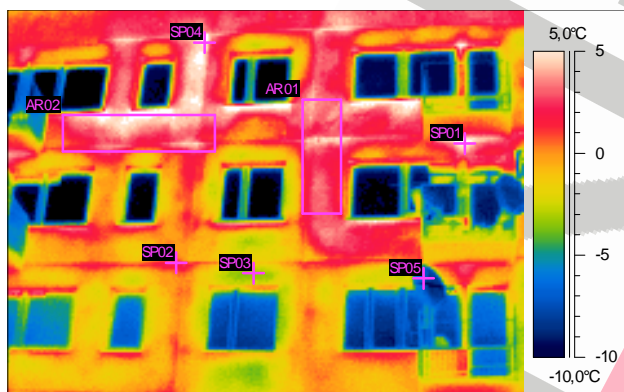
Obrazy termowizyjne budynku. Elewacja frontowa [5].
